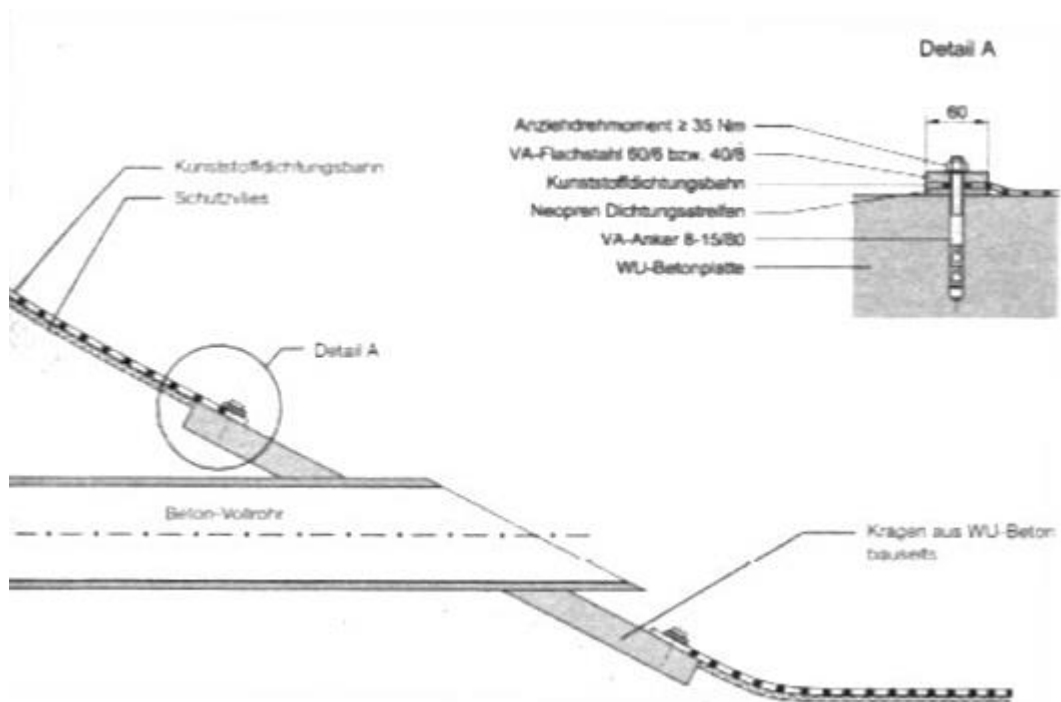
Anbindung einer KDB an ein Betonrohr mittels eines Betonkragens⁵⁷
